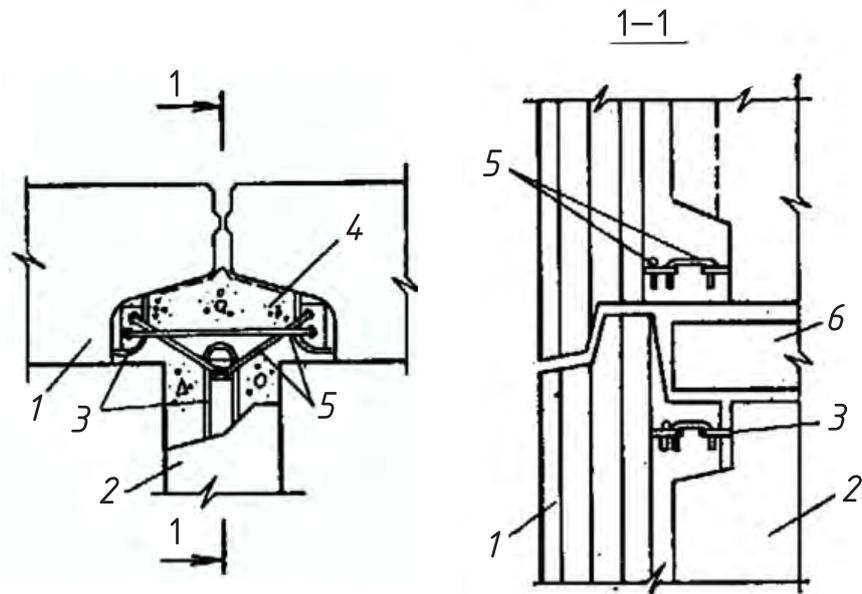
Конструкция связей замоноличиваемая типа «петля-скоба»: 1 — панель наружной стены; 2 — панель внутренней стены; 3 — петлевой арматурный выпуск; 4 — бетон замоноличивания; 5 — стальная скоба; 6 — панель перекрытия
